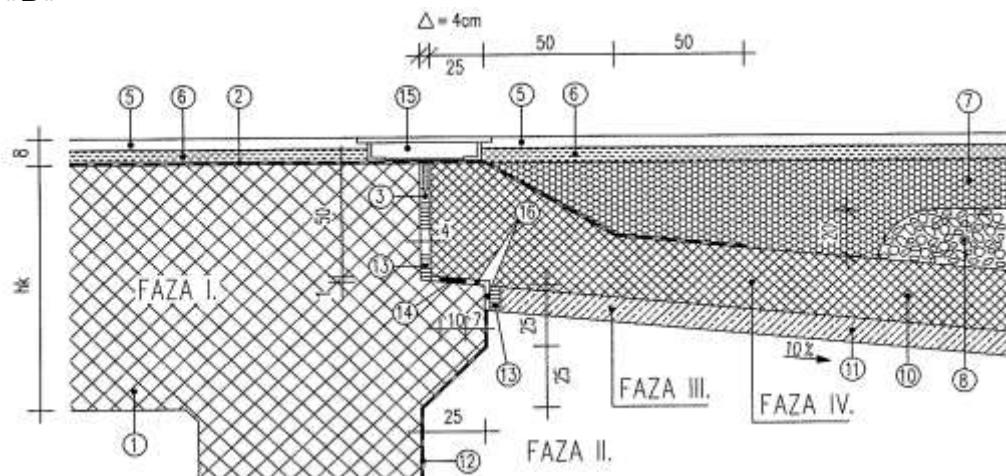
Detalj naleganja i vrha prelazne ploče kod okvirnih AB konstrukcija kada je dužina rasponske konstrukcije do 50 m
